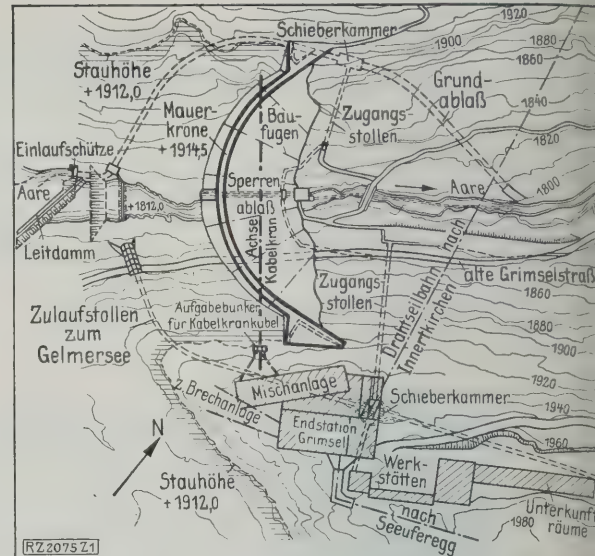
Lageplan der Spitallamm-Sperre und der Bauanlagen auf dem Nollen.
